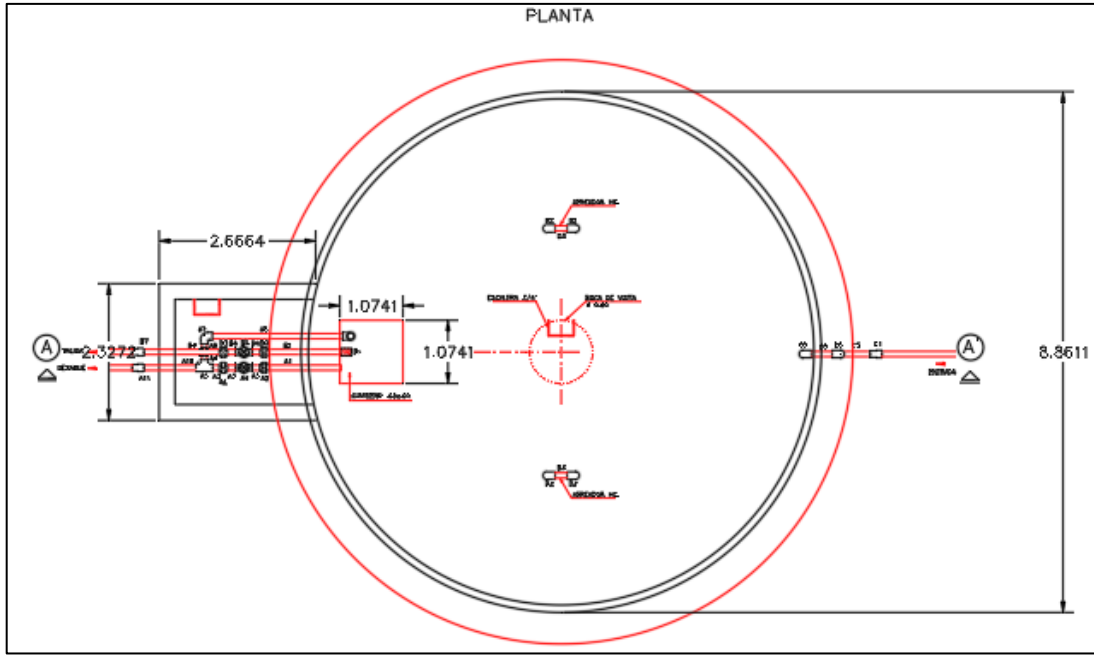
Planteamiento de mejora – Tanque de almacenamiento principal vista planta
